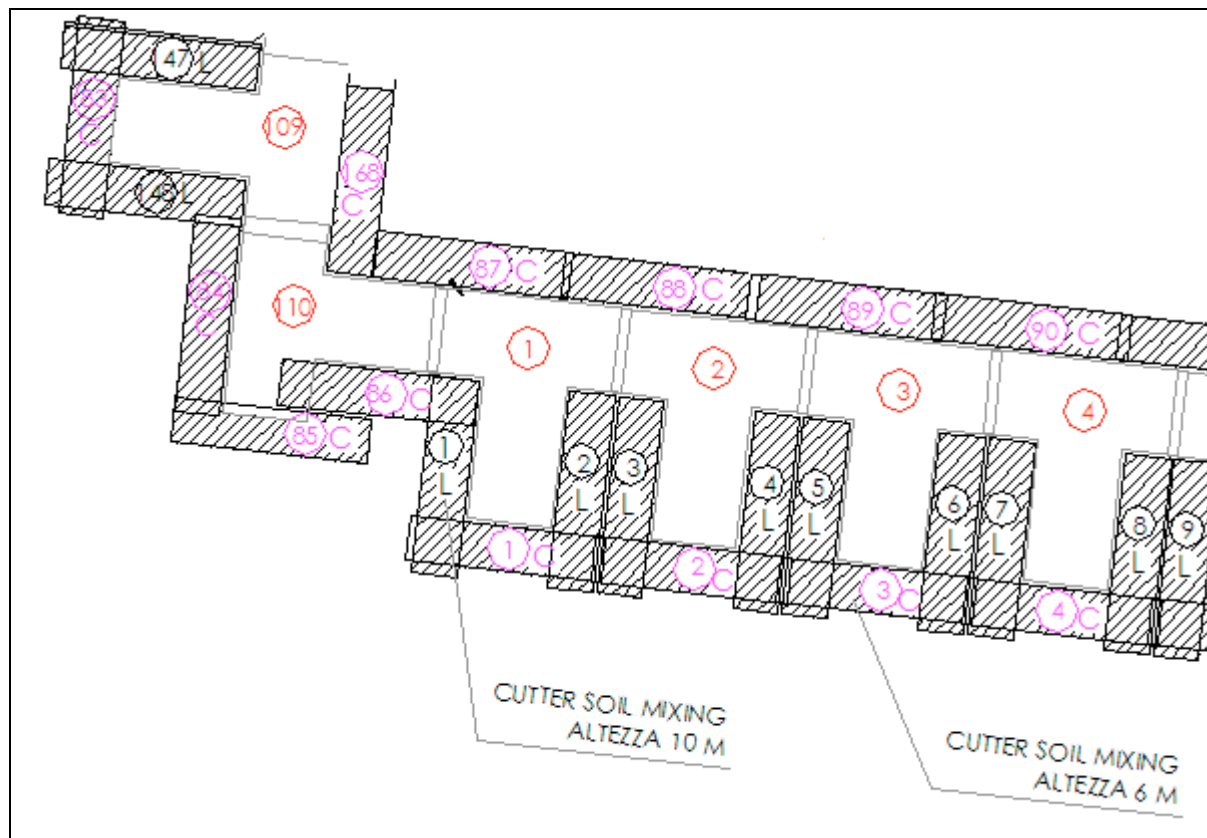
Posizione dei trattamenti di terreno rispetto ai pannelli
